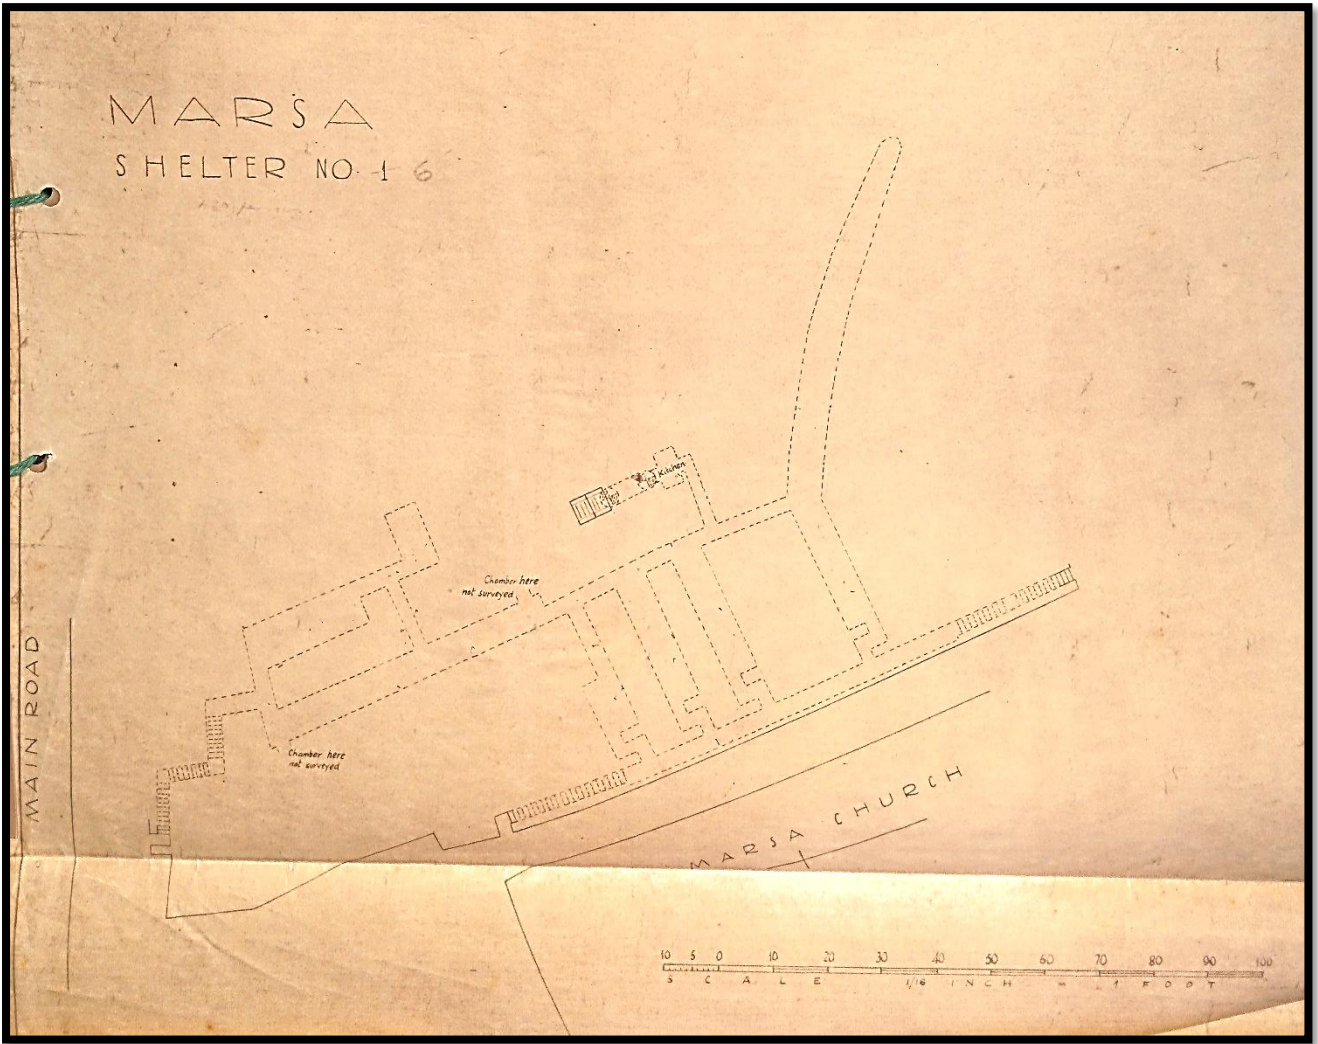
Planta do Abrigo nº16 "Main Road – Marja Church."
